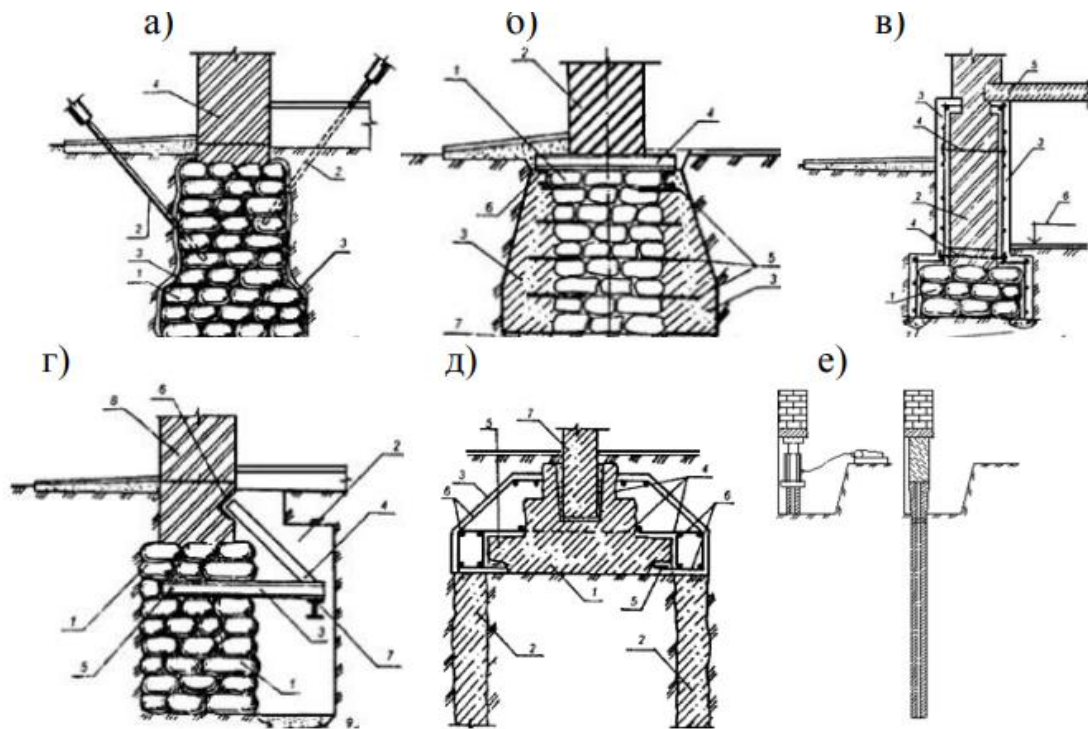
Схеми підсилення фундаментів будівель і споруд: а – цементация через пробурені свердловини; б – добетонування; в – улаштування залізобетонних обойм; г – улаштування залізобетонного банкетета; д – передача навантажень на буронабивні палі; е – передача навантажень на металеві порожнисті багатосекційні палі
